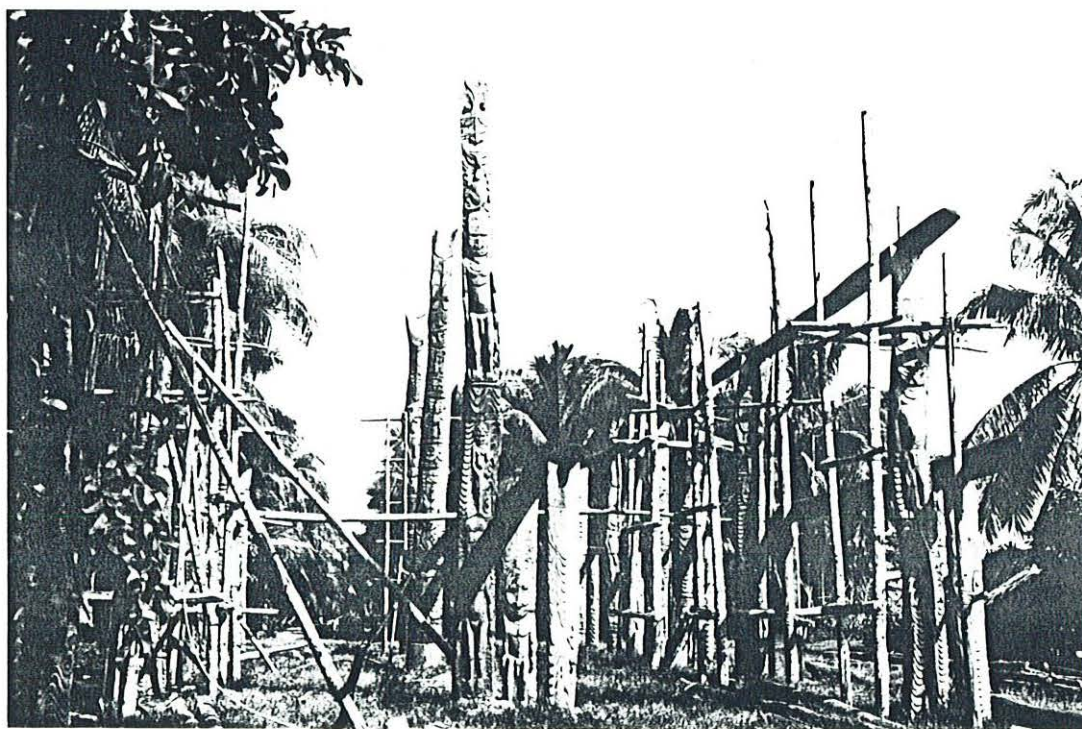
(A & B) - Maison cérémonielle de Korogo en construction (1988). Les outils de levage sont encore en place.
